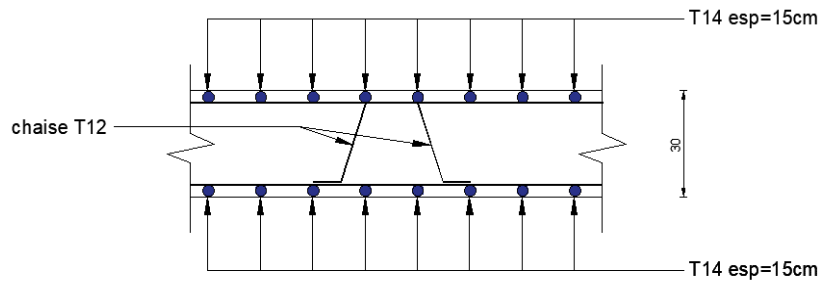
Schéma de ferrailage de la dalle du radier sur travée sens y-y.
